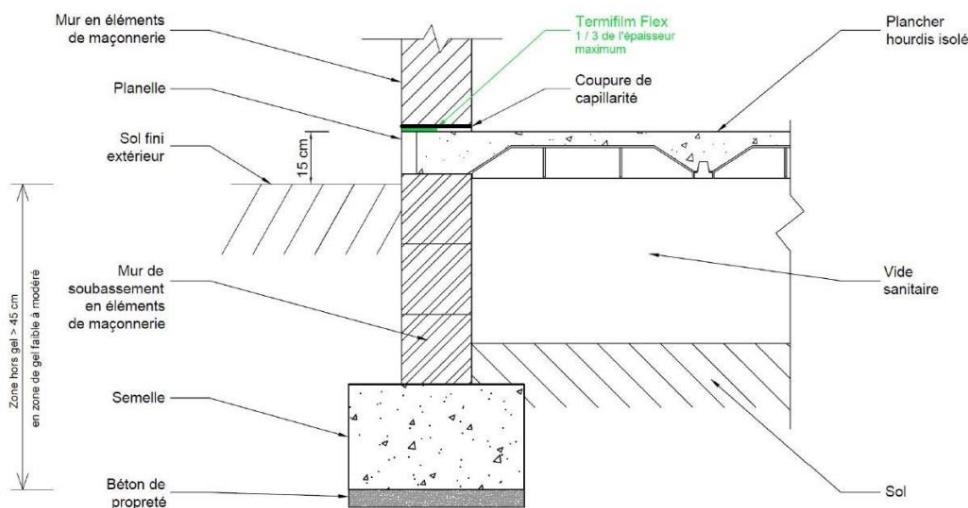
Plancher à poutrelles, vide sanitaire<60cm (Disposition autorisée en zone sismique uniquement pour les maçonneries de plus de 30cm d'épaisseur)
